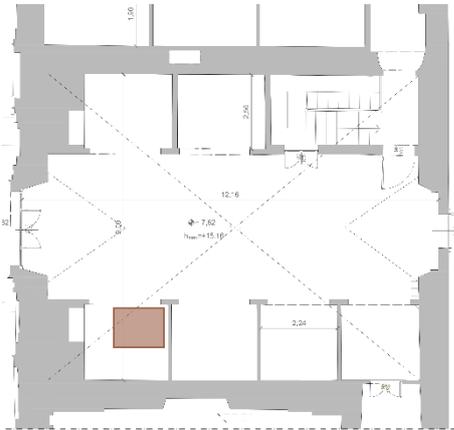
Deterioramento dovuto a usura su pavimento in cotto, alcova C (secondo piano nobile)
